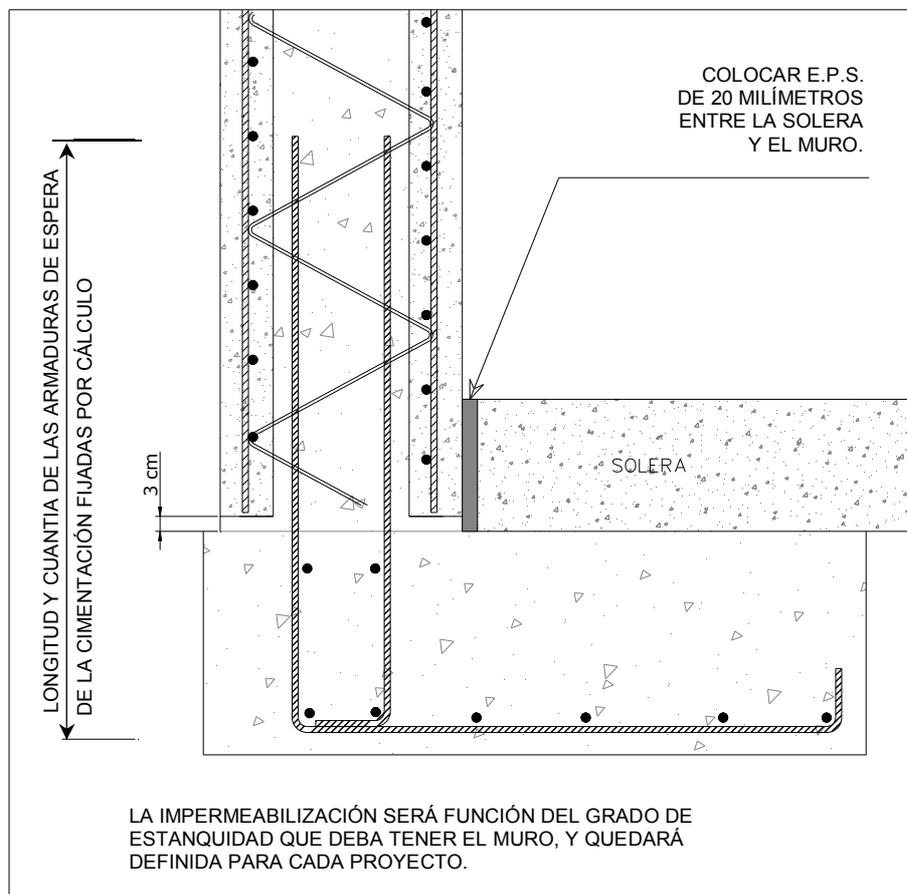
DETALLE DE UNIÓN CON ZAPATA CENTRADA
